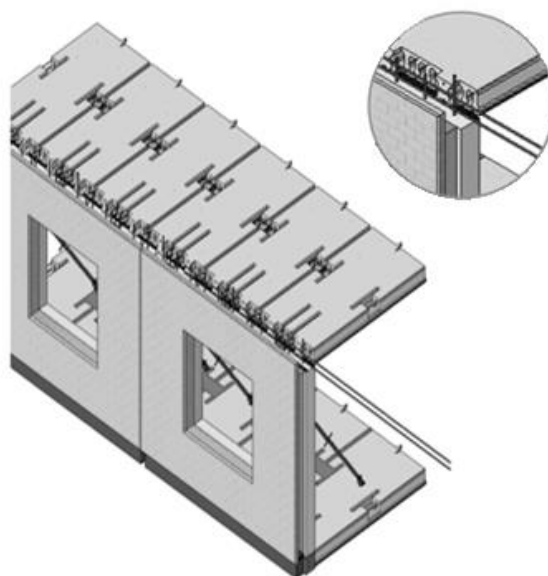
Сопряжение стеновых панелей и плит перекрытий с межпустотными усилителями
